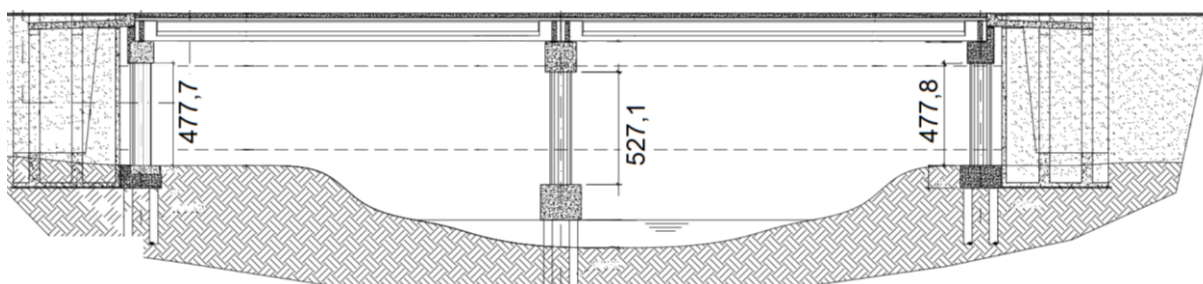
Ponte em vigas sobre o córrego Jaguaribe – cotas em cm. Fonte: adaptado de Mato Grosso (2023).
